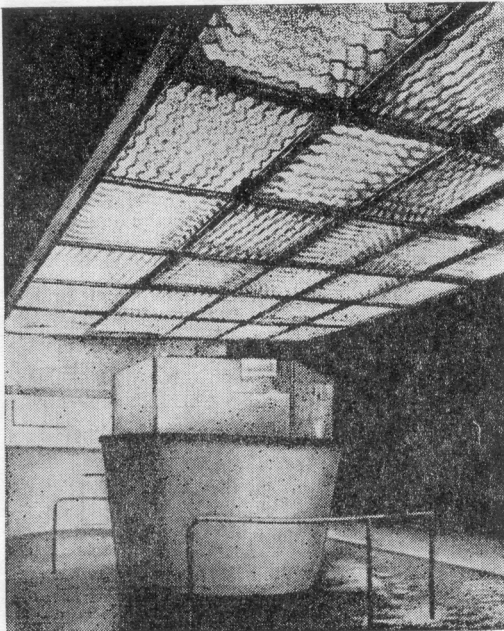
Construcție anexă la o fabrică de placaje, executată din placaj ondulat blindat (după Perry)
